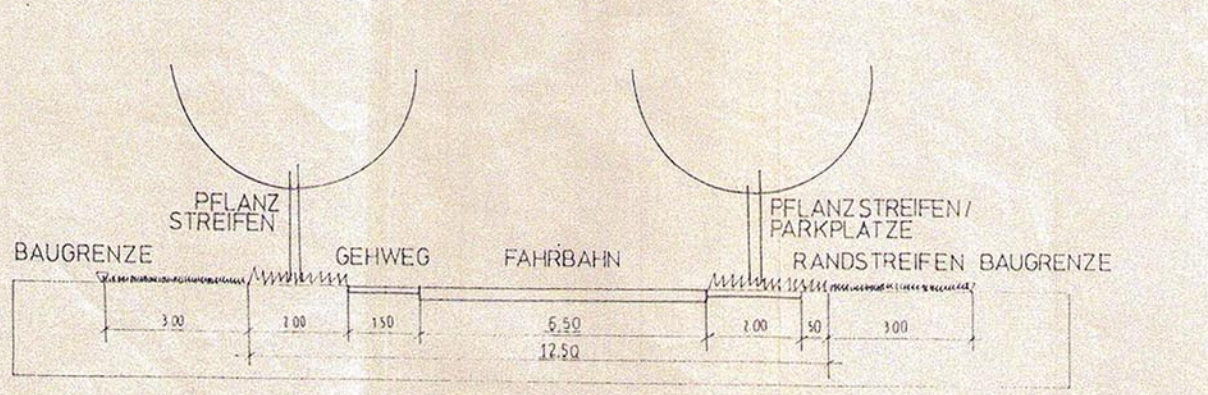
DETAIL VERKEHRSDÄMPFUNG G M: 1:200
